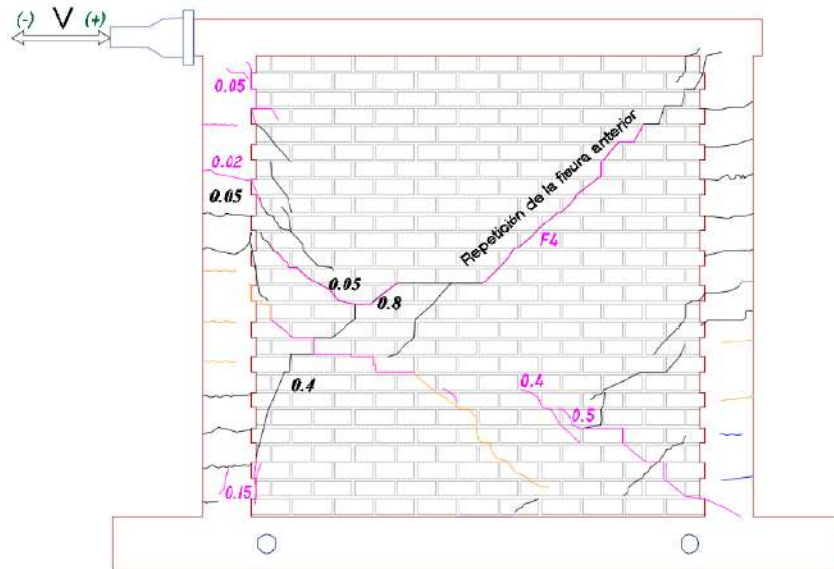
Plano del muro agrietado diagonalmente en la fase 4.
